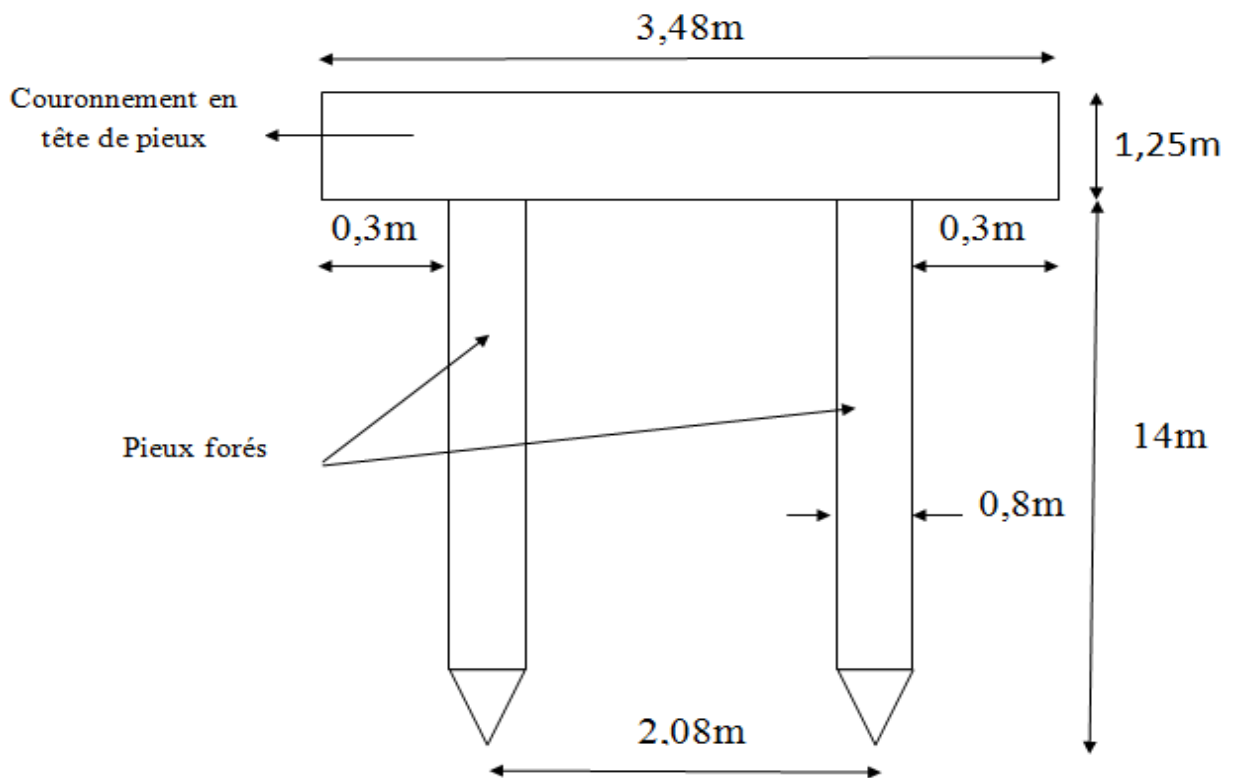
Détail d'exécution des pieux et de la poutre de couronnement.
